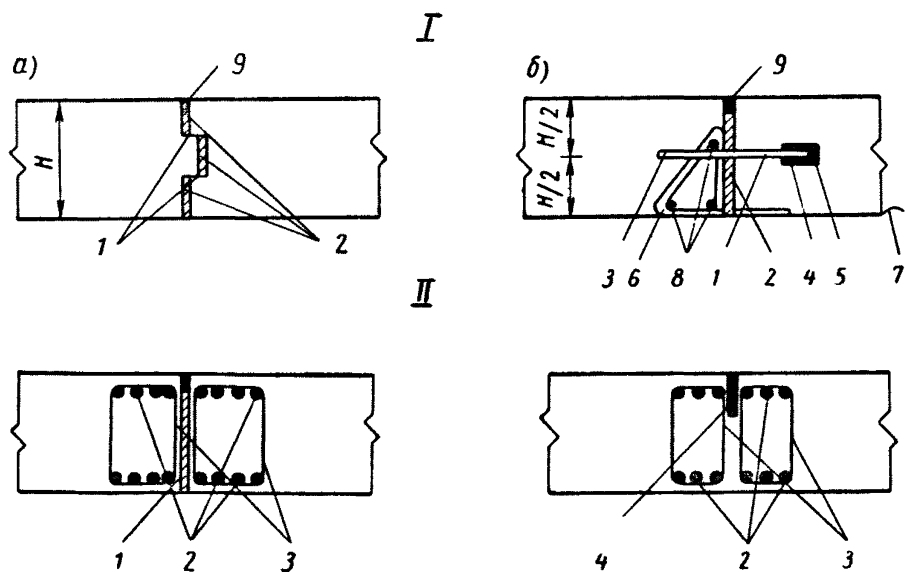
Конструкции стыковых соединений и усиления краев плит бетонных покрытий
